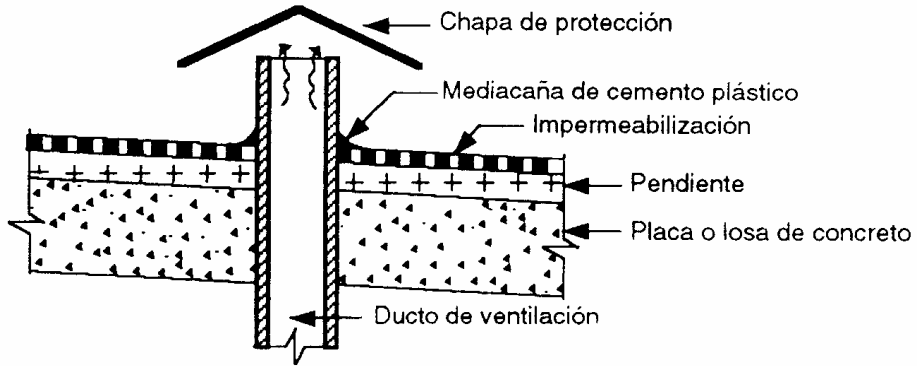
Impermeabilización de la tubería de ventilación
